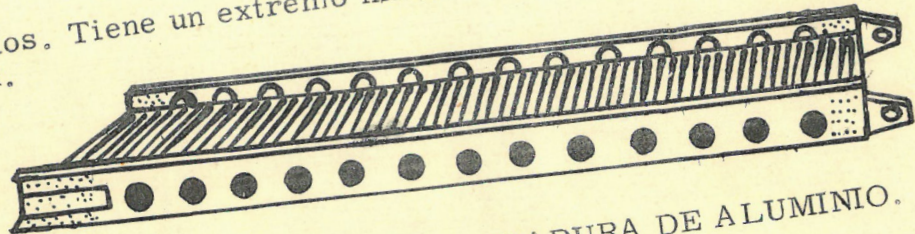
PLANCHA DE RODADURA DE ALUMINIO.
